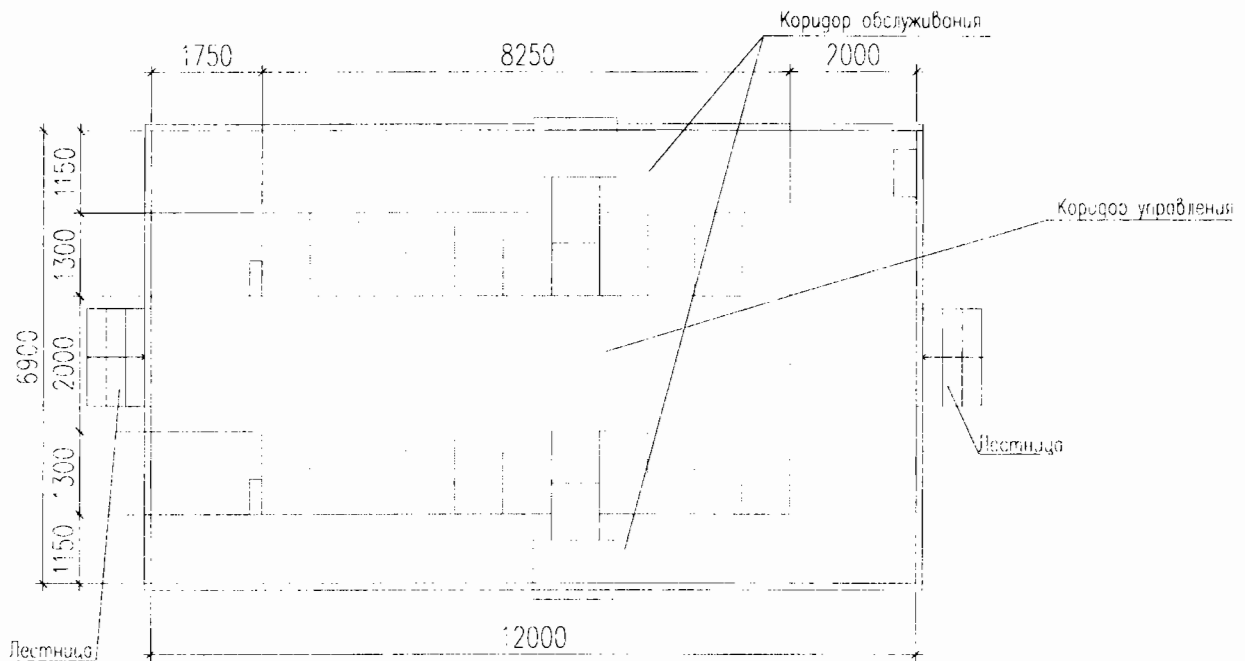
План расстановки оборудования. Вариант с шинными вводами на две стороны
